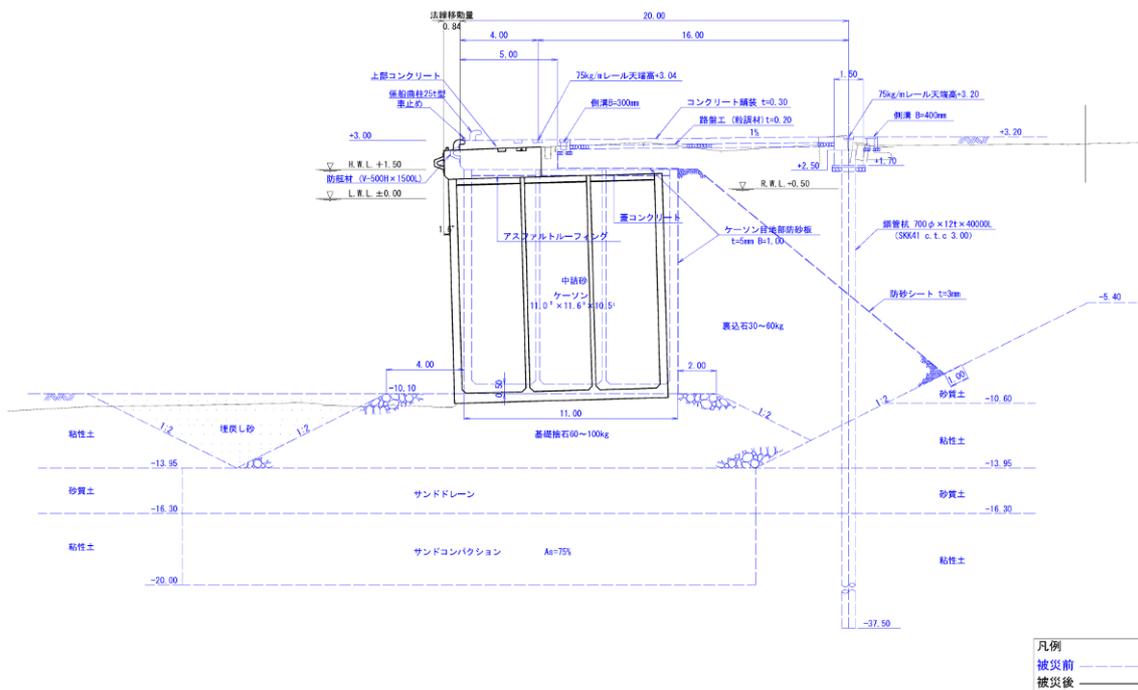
No.10 日立港区_第4ふ頭地区 4-D 岸壁 (-10.0m) の断面図 (被災前・後)
